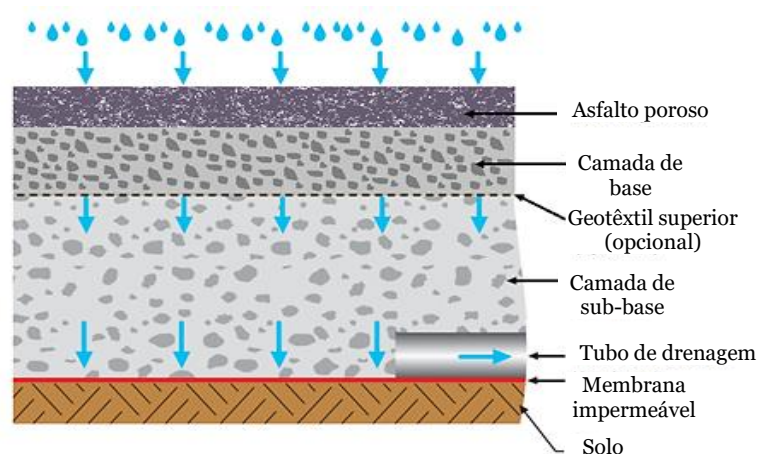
Perfil esquemático – armazenamento (Adaptado de Interpave, 2010)
